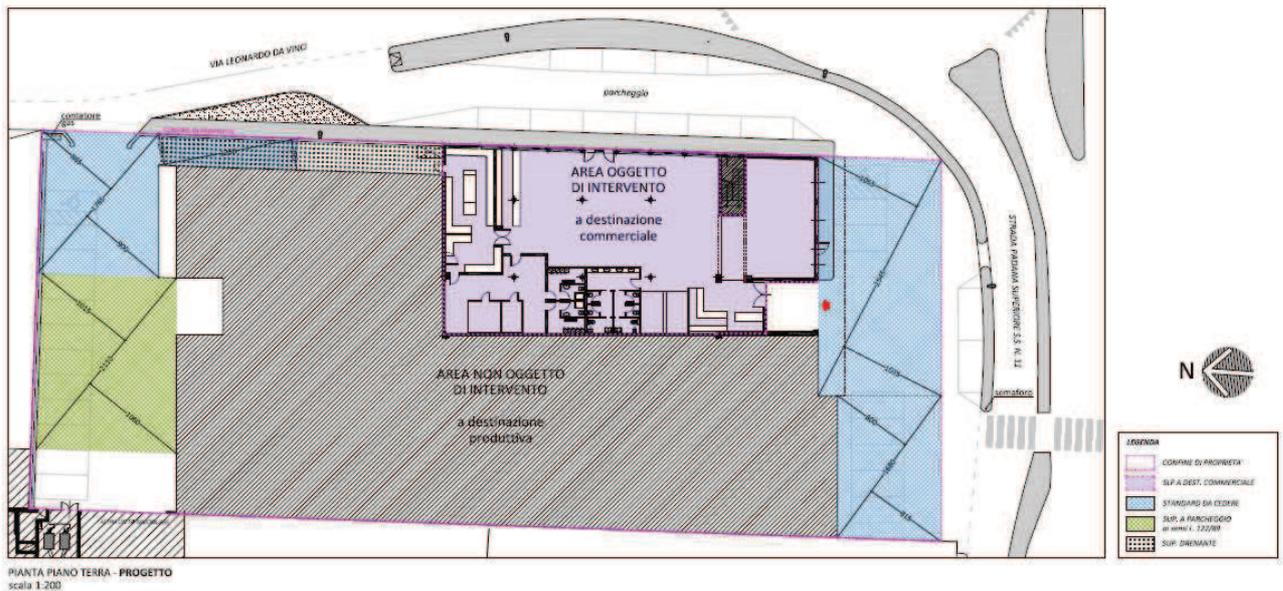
planimetria di progetto – Progetto Studio Recalcati - settembre 2016
